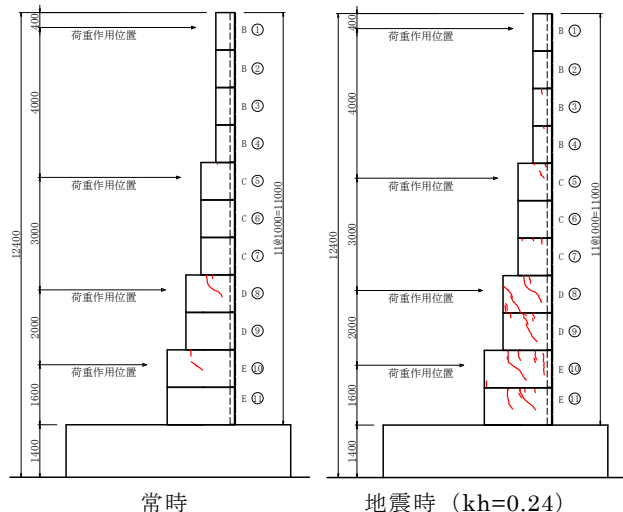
試験体のひび割れ発生状況 (試験体1)
